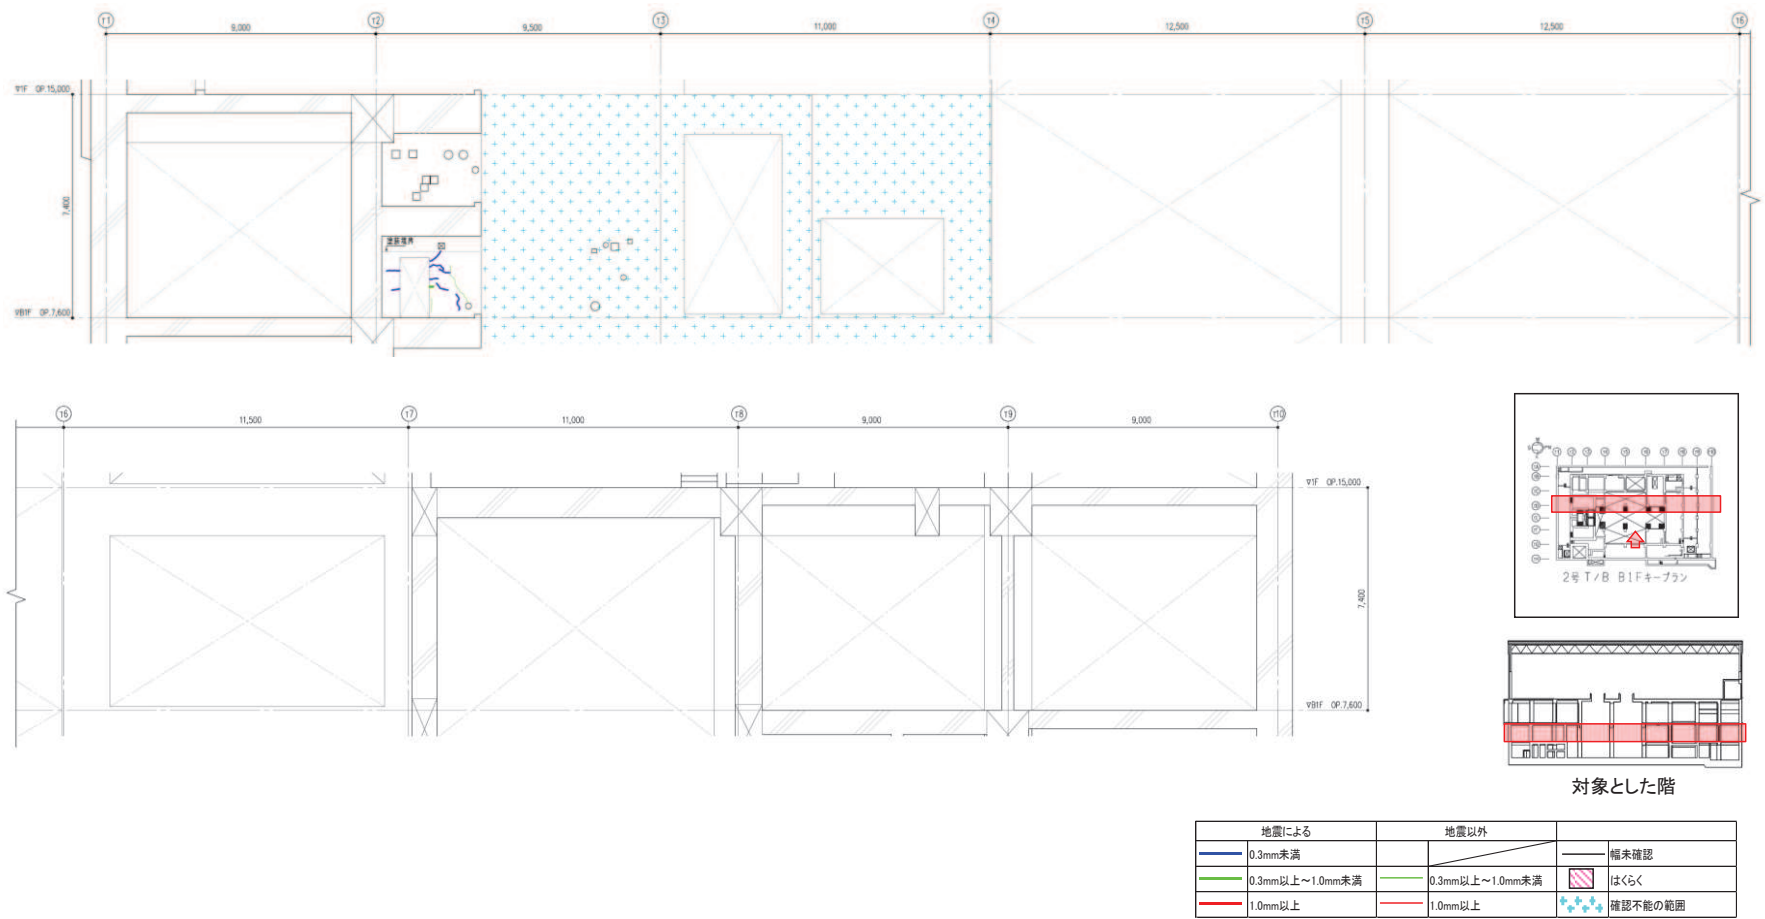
タービン建屋のひび割れ分布 耐震壁 (29) 地下1階 TD 通り
